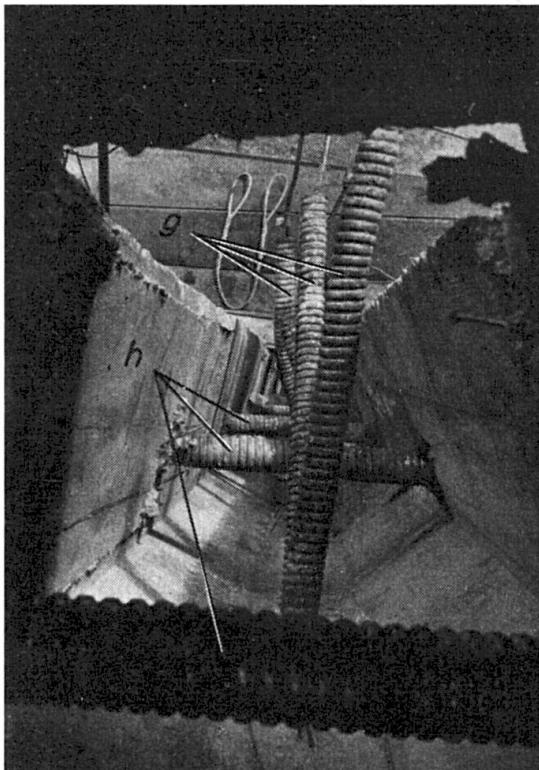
Vue plongeante du logement de la clavette amont d'un joint actif. On distingue les câbles horizontaux (*h*) traversant la clavette et les gaines de protection des tubes d'alimentation des vérins plats (*g*).
